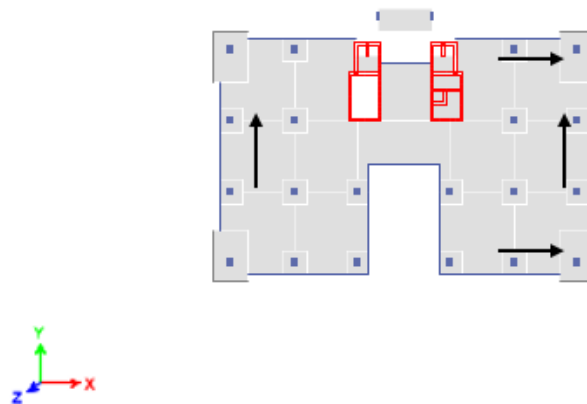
Esquema de ubicación de sensores en la Cuarta planta de la estructura. Instrumentación Tipo 4.
